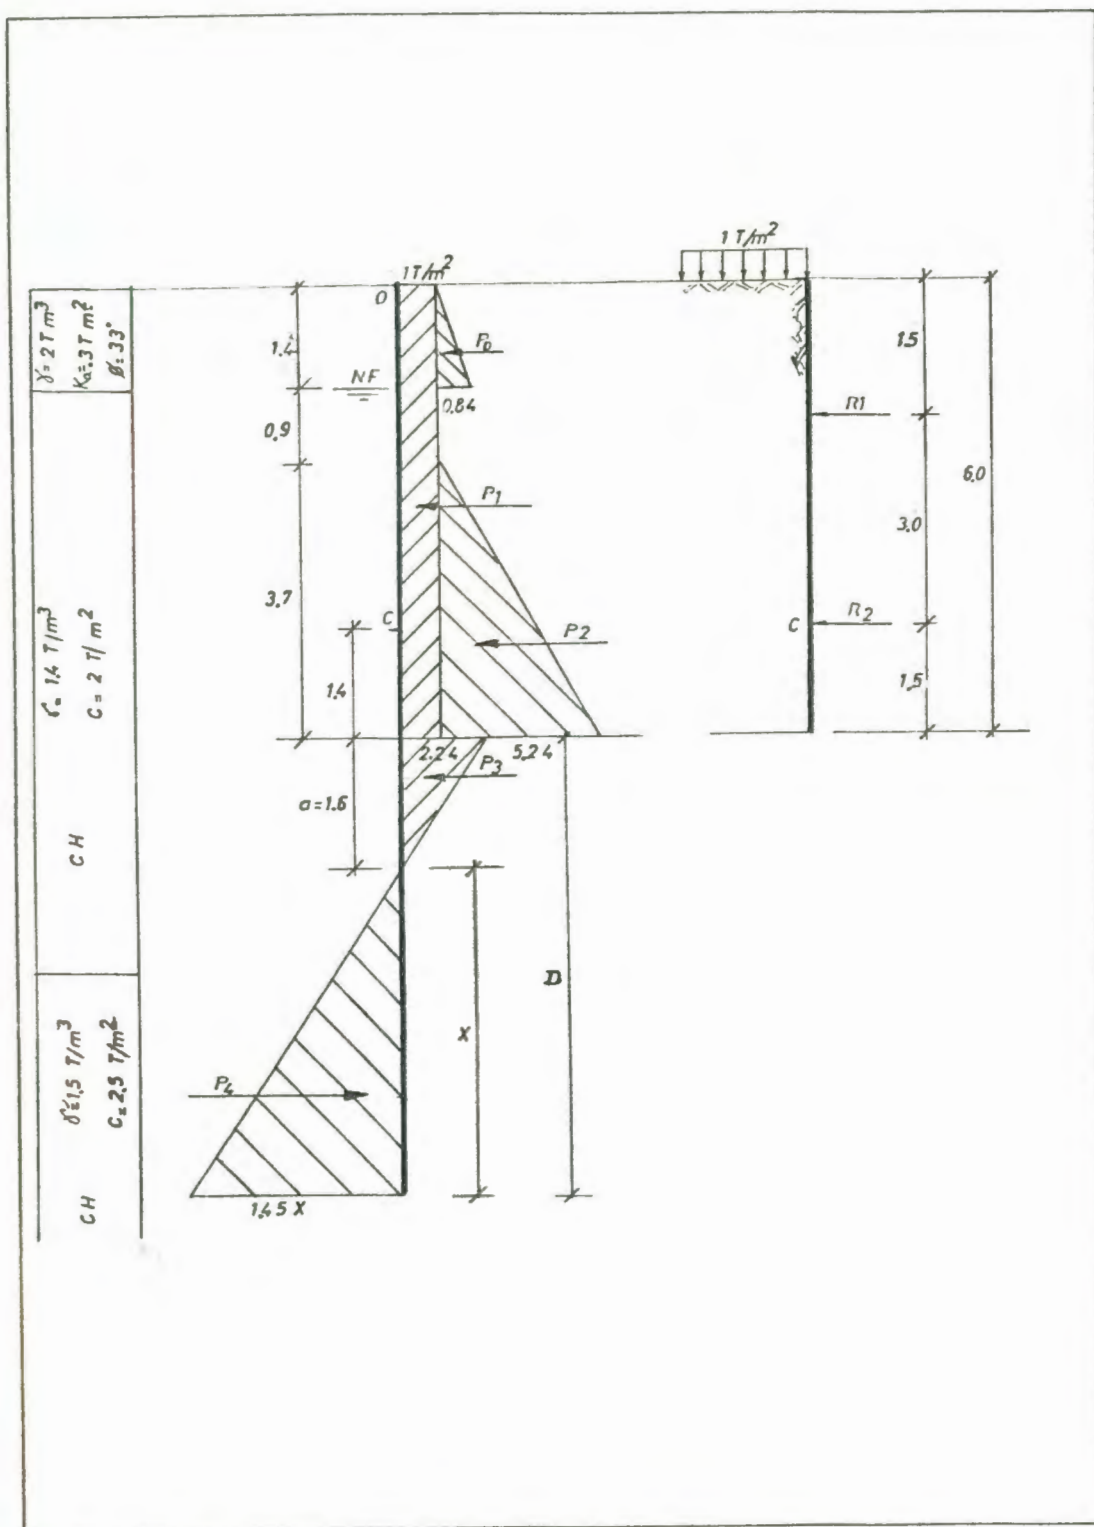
Nivel 1 de excavación (Cota - 6m.)
